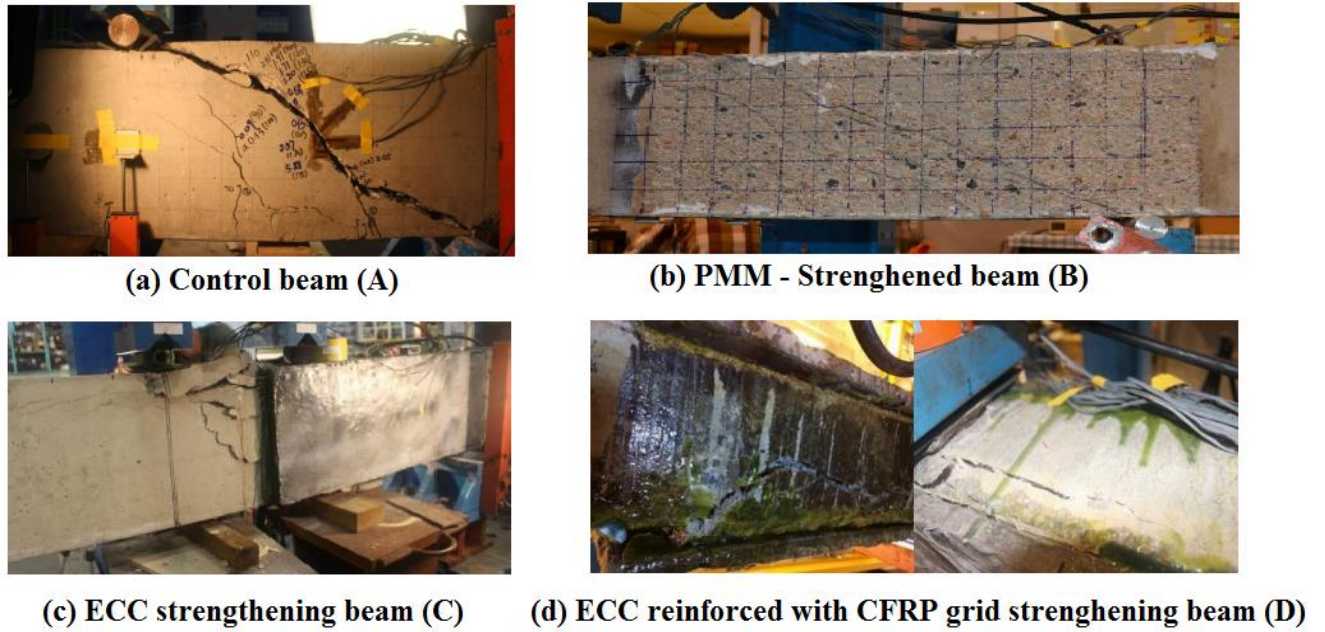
Mode de rupture des poutres testées [Yang, X et al 2017].
